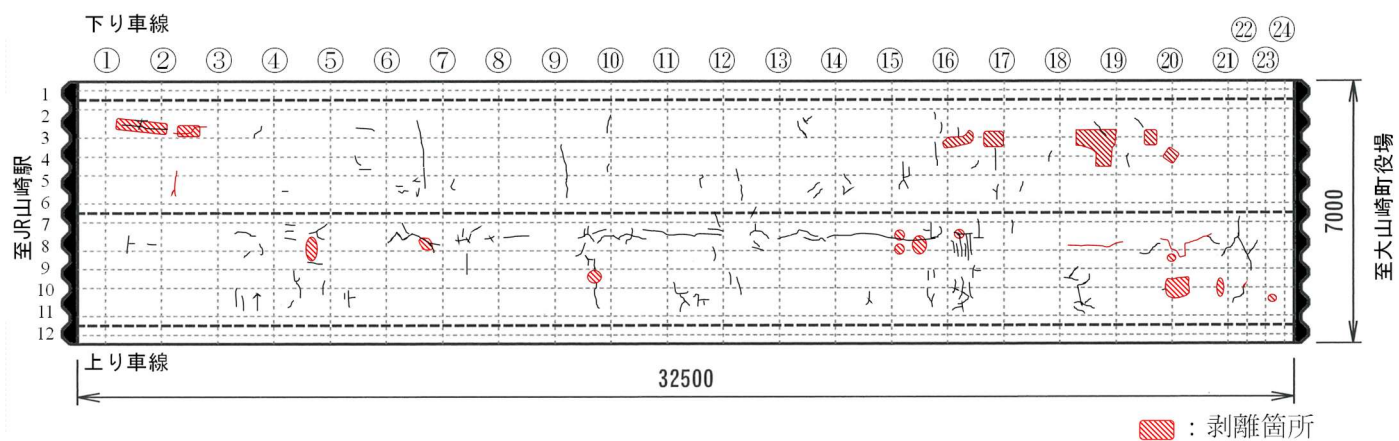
供用5年(夏季)ひび割れ図(2021年9月)
